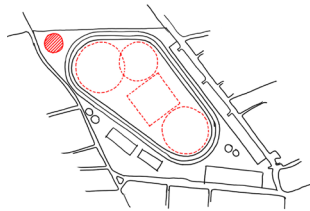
Planta General Boceto 03. Elaboración Propia.
